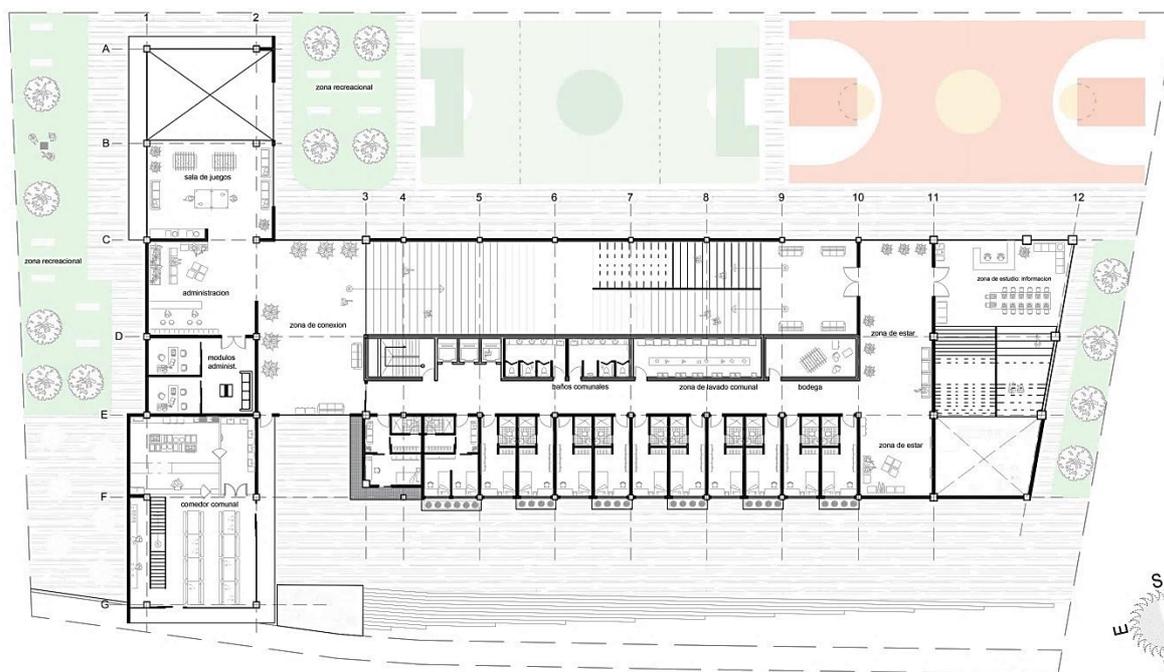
Planta: piso 2 Cevallos. (2018). Creación propia
